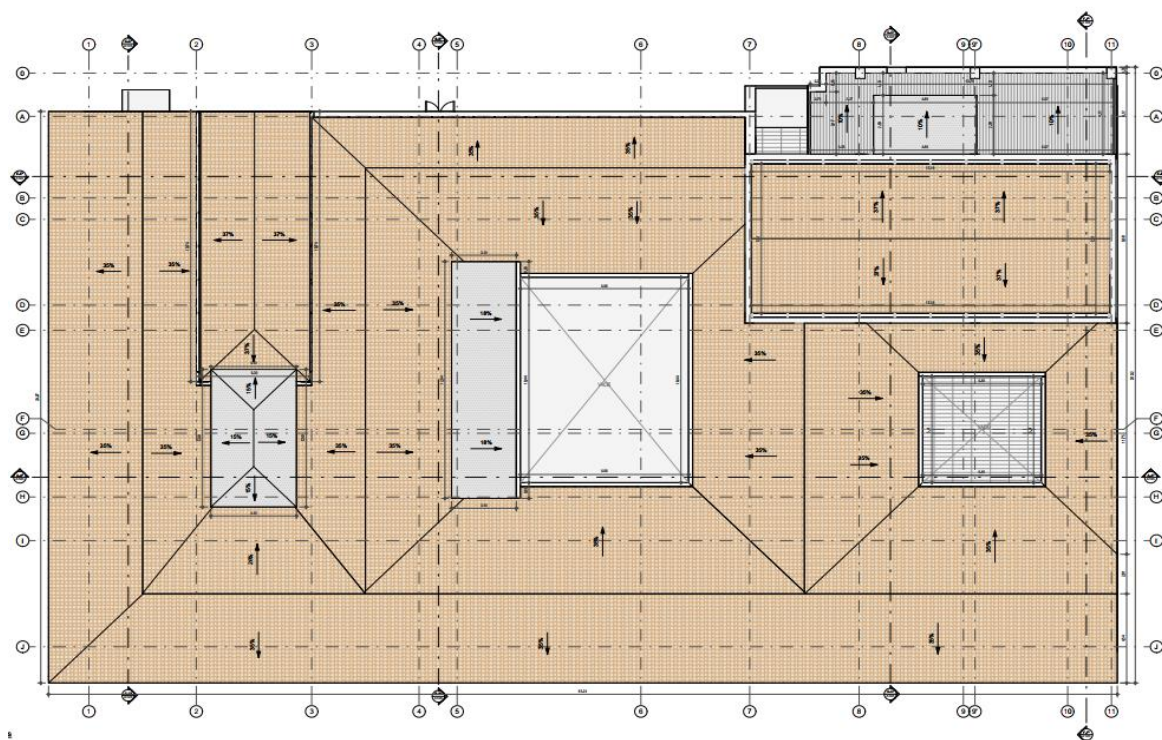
Planta de Cubiertas – Casa de Gobierno – Salgar, Antioquia
